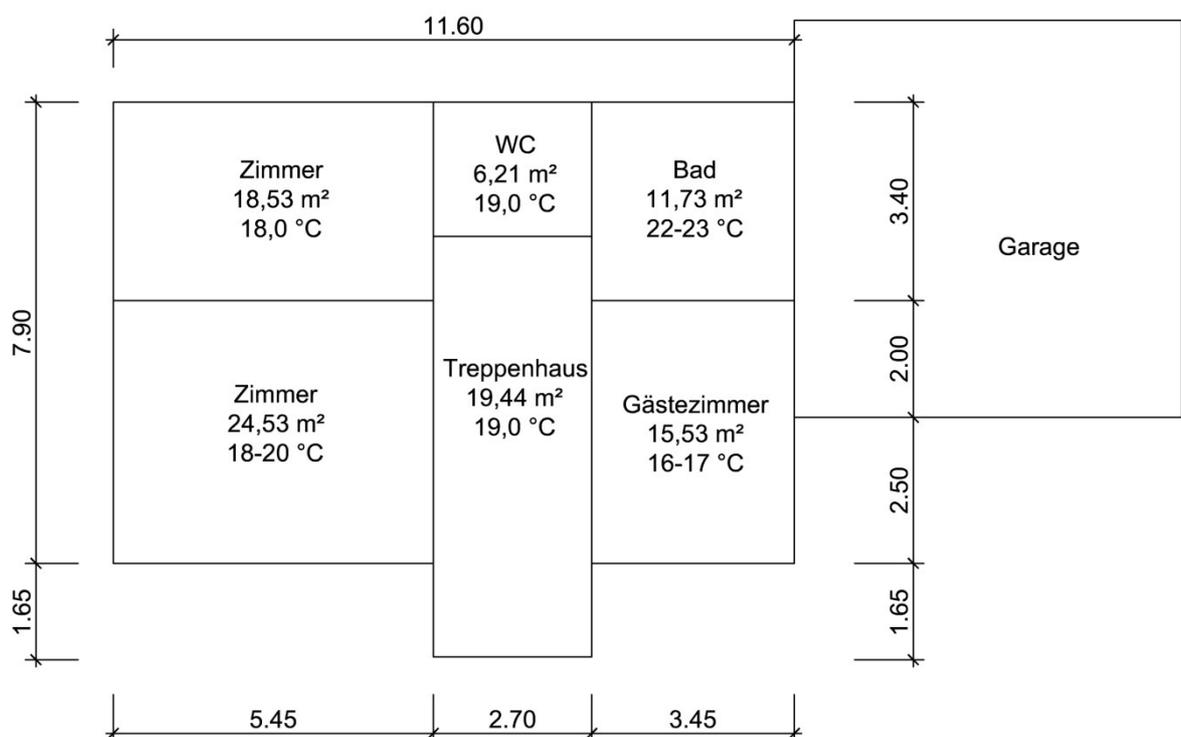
Grundriss: konditioniertes Obergeschoss
